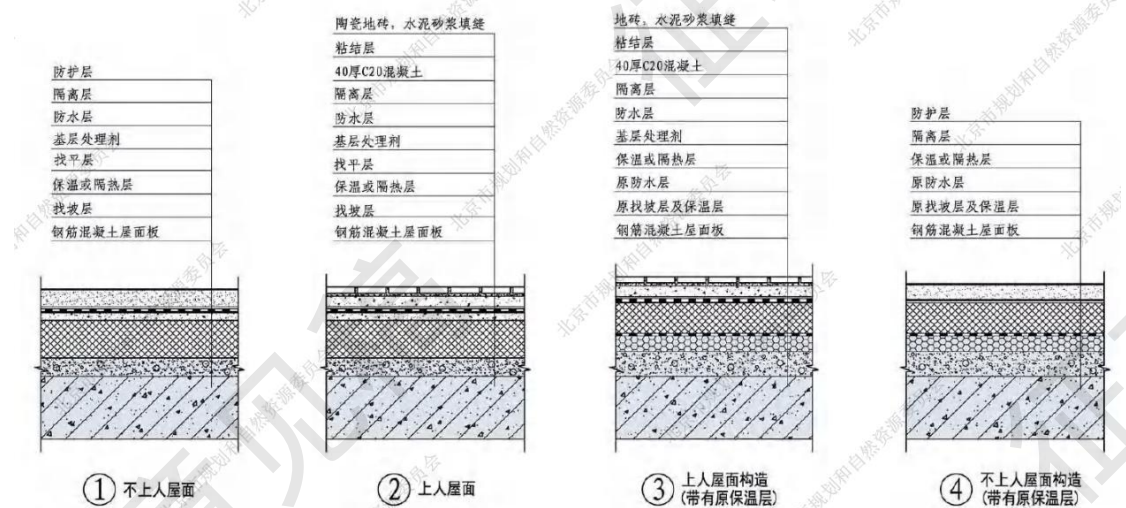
平屋面构造示意图 (选自《既有建筑节能改造》16J908-7)
